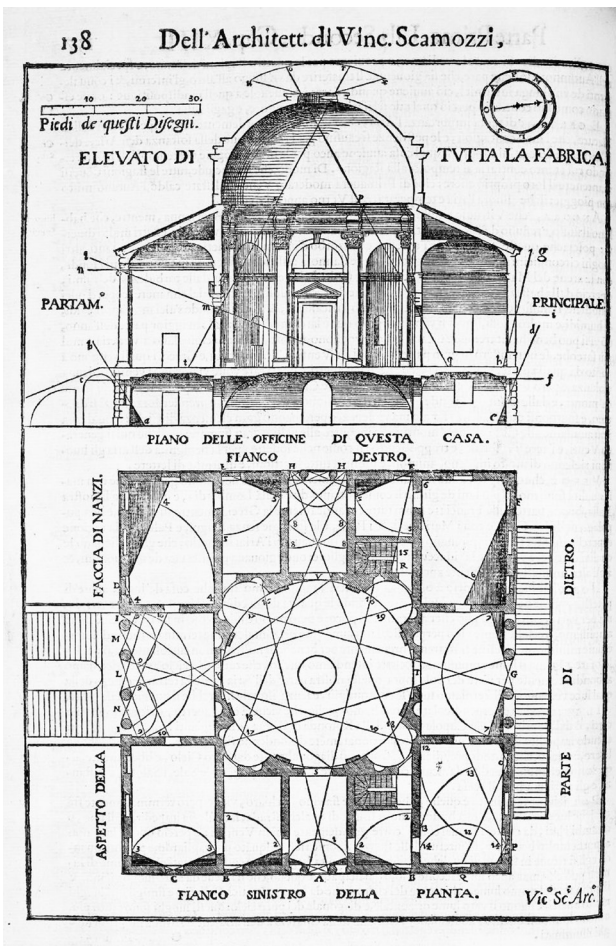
Palladio, planta, sección y alzado de la Villa Rotonda. Palladio 2015.
